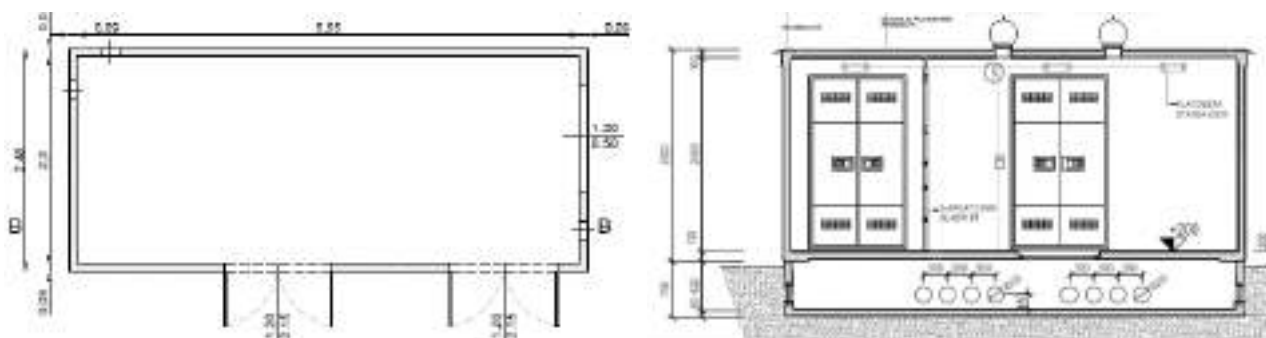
Pianta e prospetto della cabina di sezionamento
